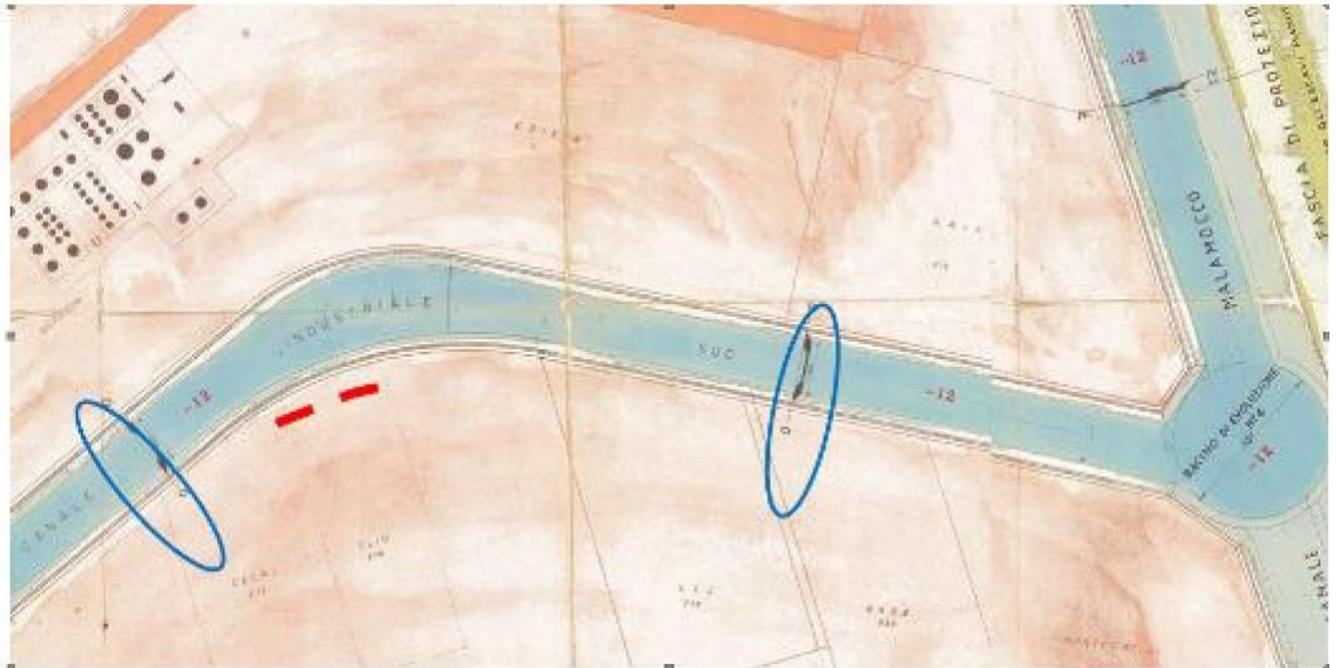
Planimetria PRP con evidenziate le Sezioni 0 – 0 del Canale Industriale Sud (blu) e indicazione della banchina oggetto di intervento (rosso)
